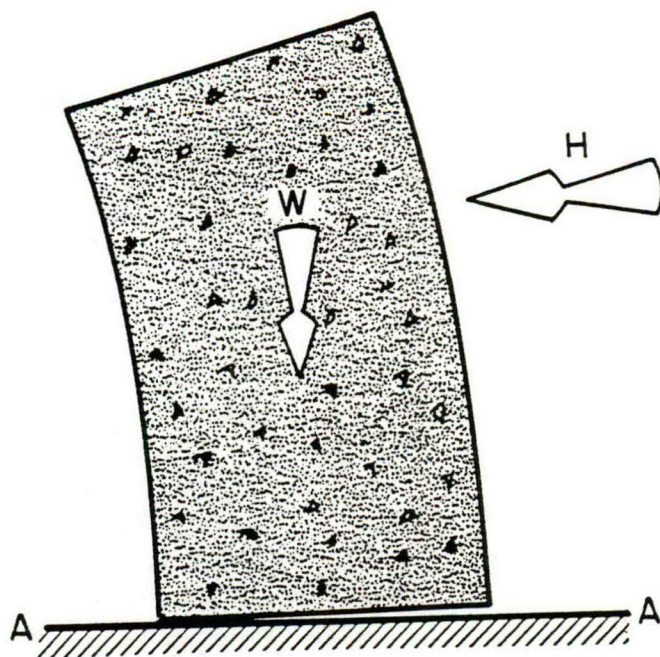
Condiciones de carga sobre un muro estructural.
